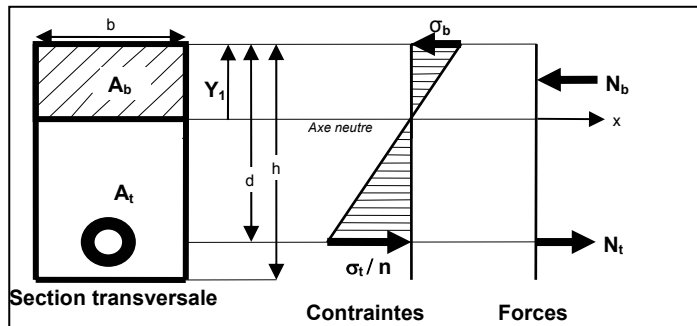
Section transversale d'une poutre en béton renforcée par une tige creuse
